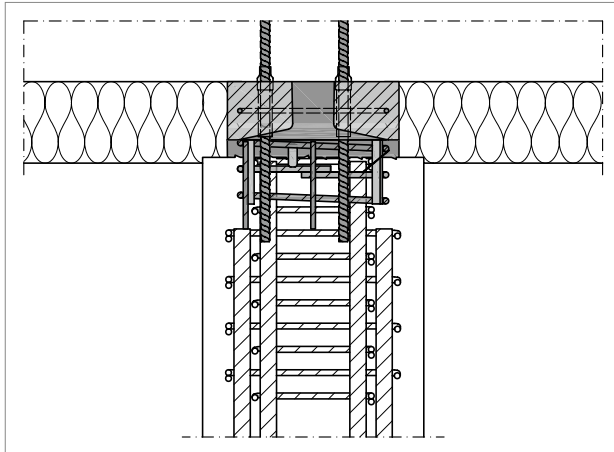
Schöck Sconnex® Typ P-O: Bewehrungsführung im Bereich 2 – Stützenlängsschnitt (gilt auch für Typ P-U)
